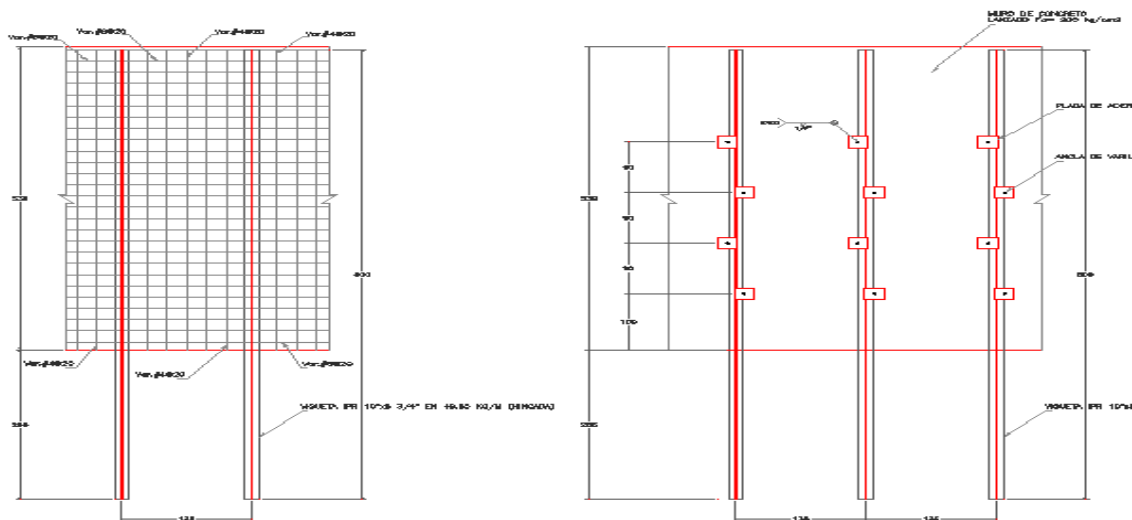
Muro de concreto lanzado y anclaje de muro
